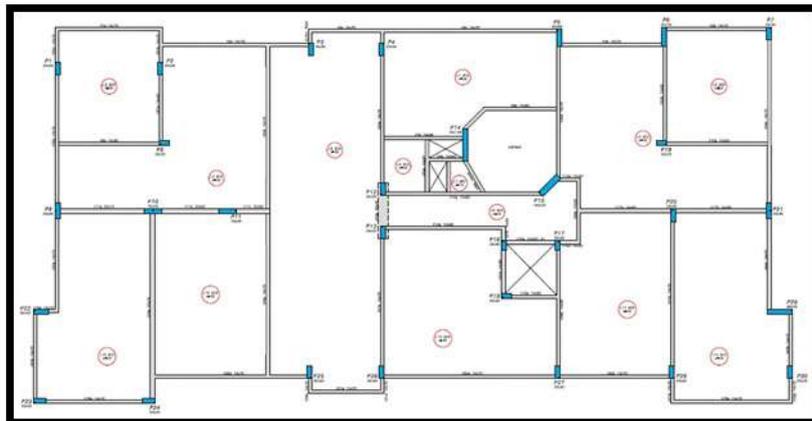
Projeto estrutural – forma do tipo (sem escala)
